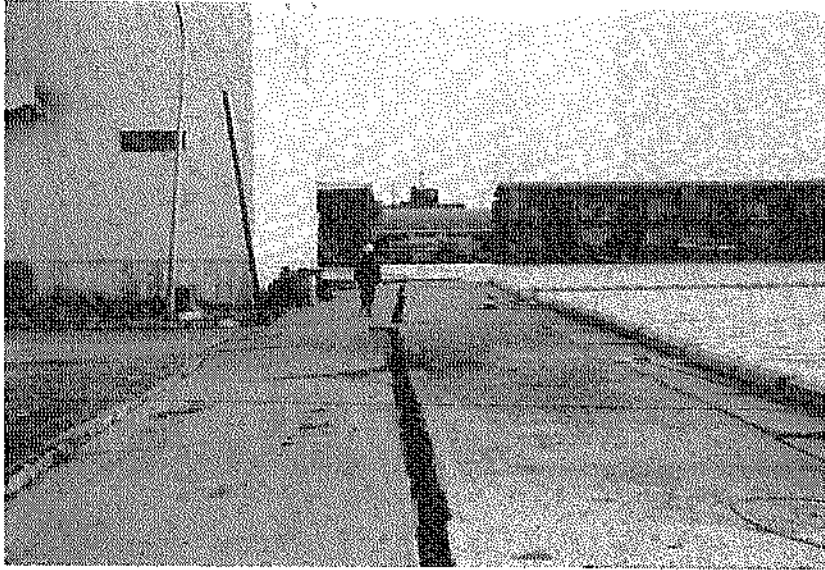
被災状況北埠頭②東岸壁 (-8.1m)
